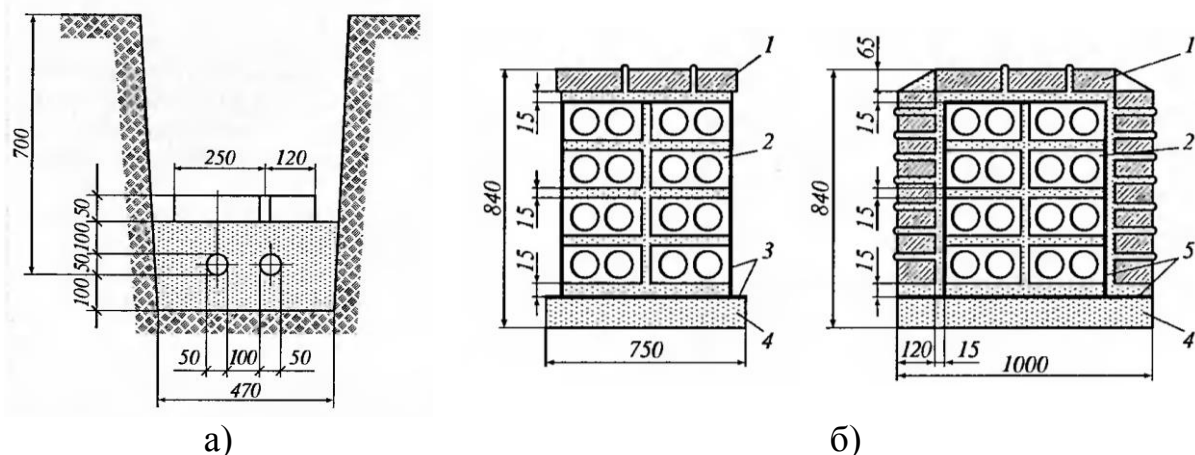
Прокладка кабелей в земляных траншеях и железобетонных блоках
